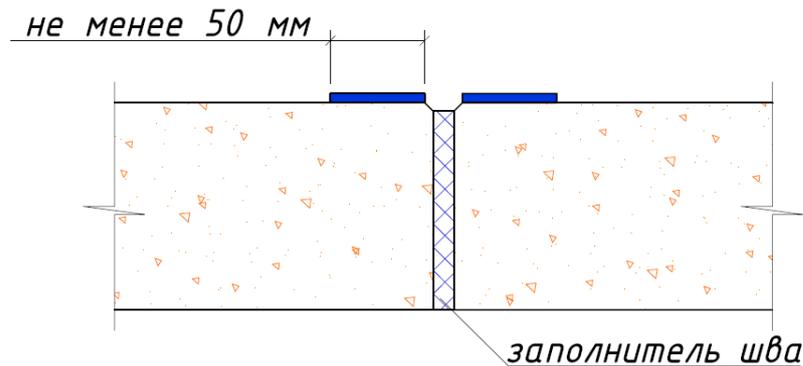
Зона подготовки шва горизонтального и стыка стена-пол.
